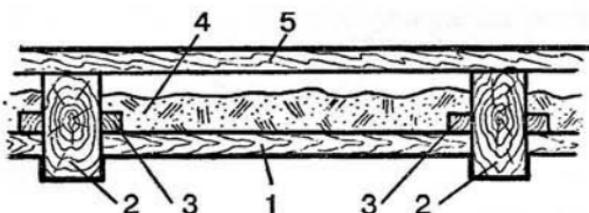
Деревянная обшивка потолка, втопленная в конструкцию перекрытия:
